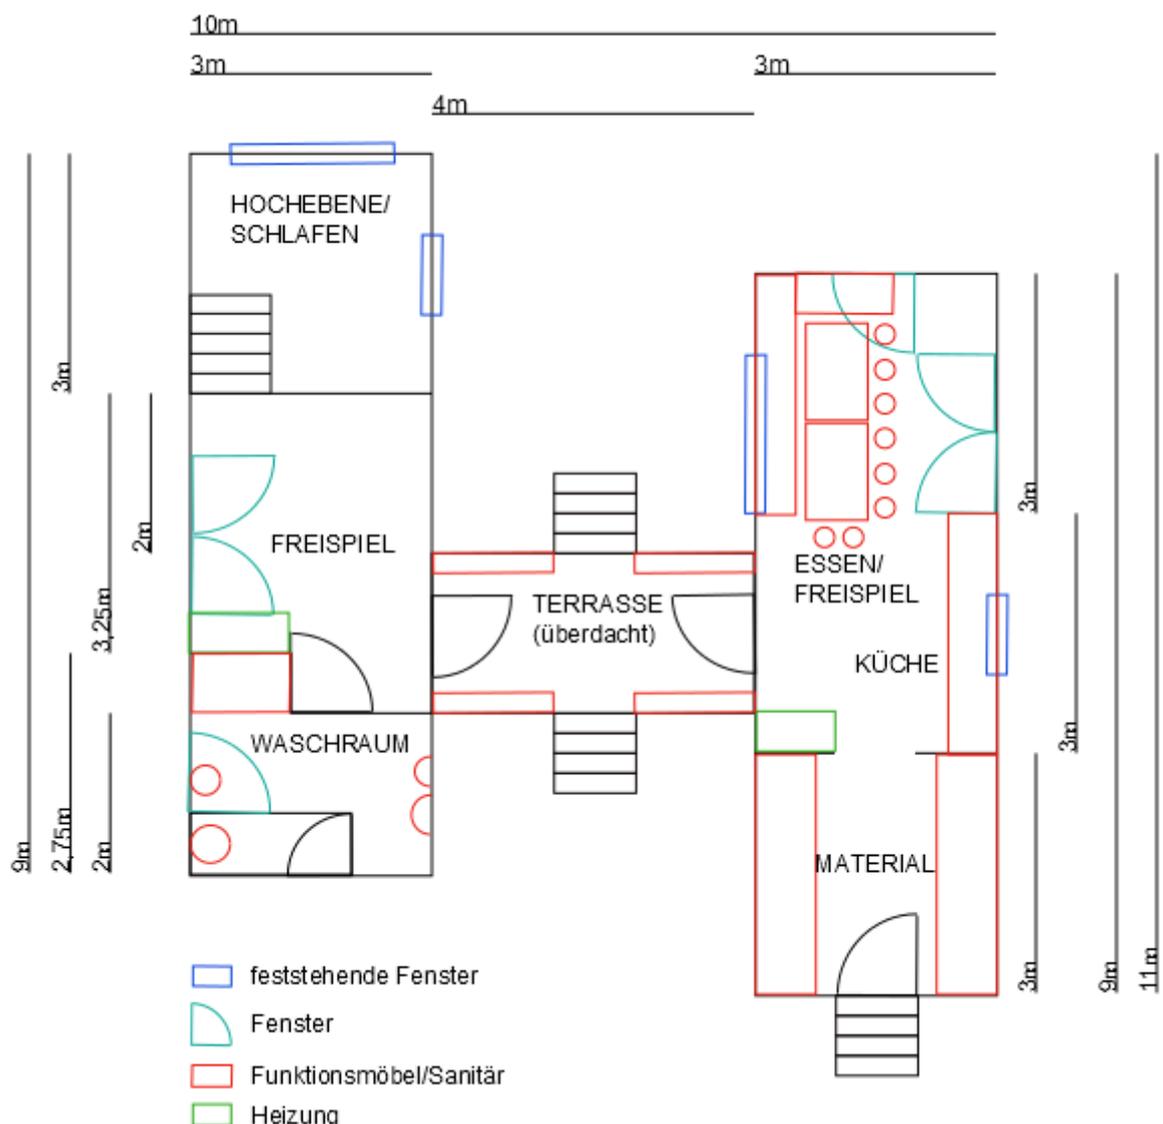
Grundriss der Bauwagenlösung
